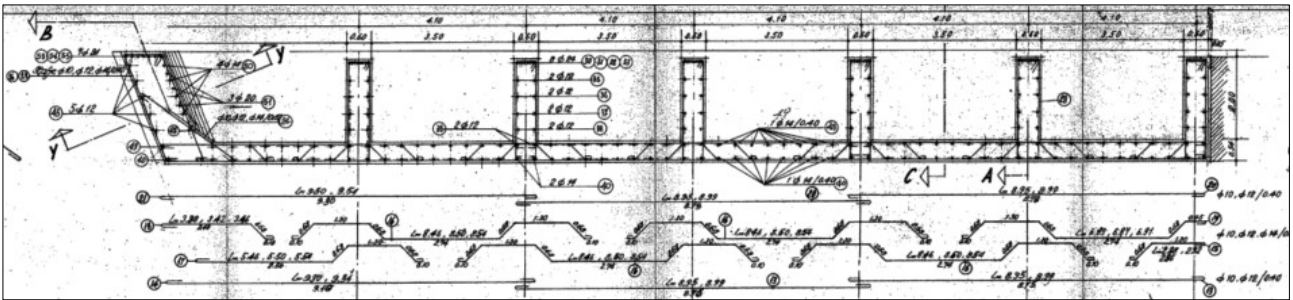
Documento as-built “Sottovia Via del Triumvirato dell’autostrada A14 al km 9+201” – Sezione orizzontale con armature spalla
